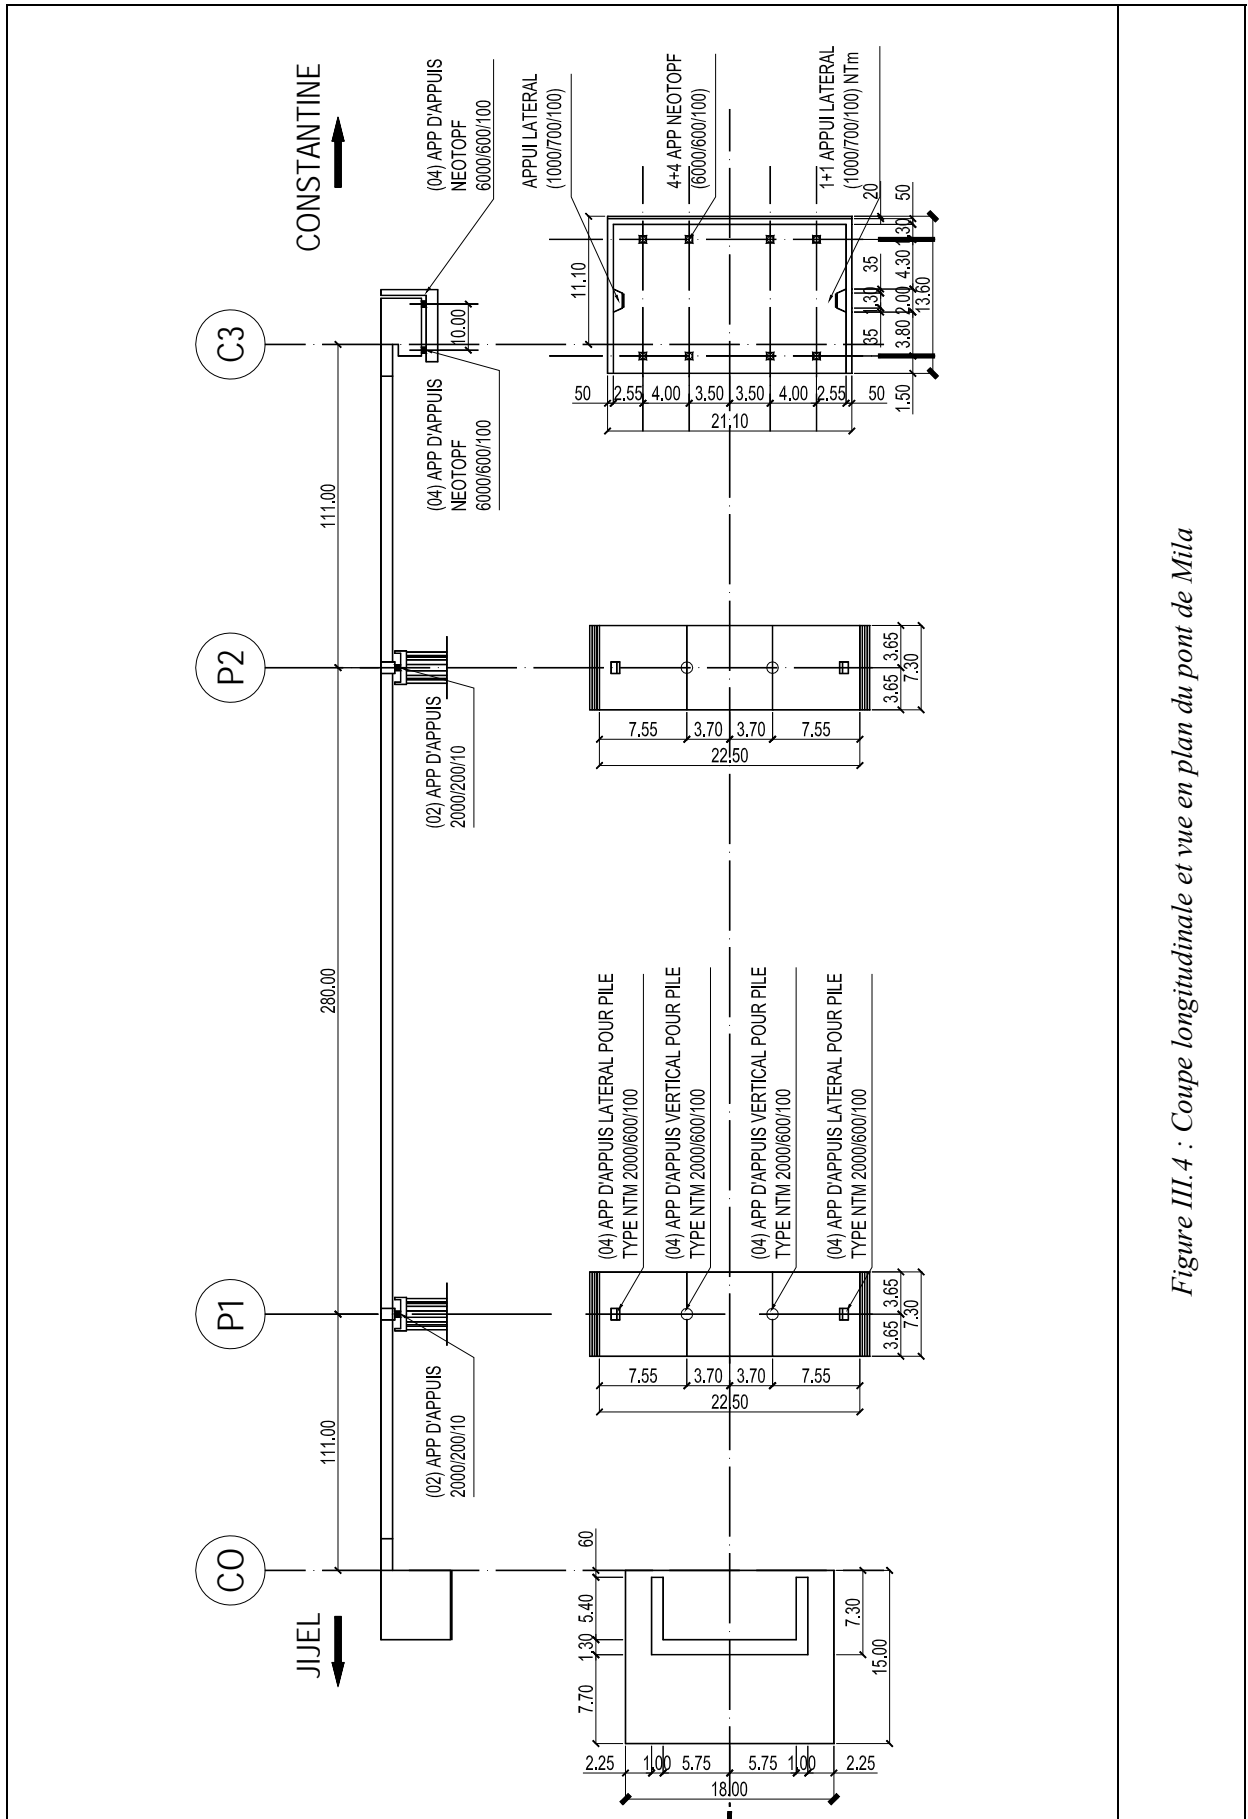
Coupe longitudinale et vue en plan du pont de Mila
